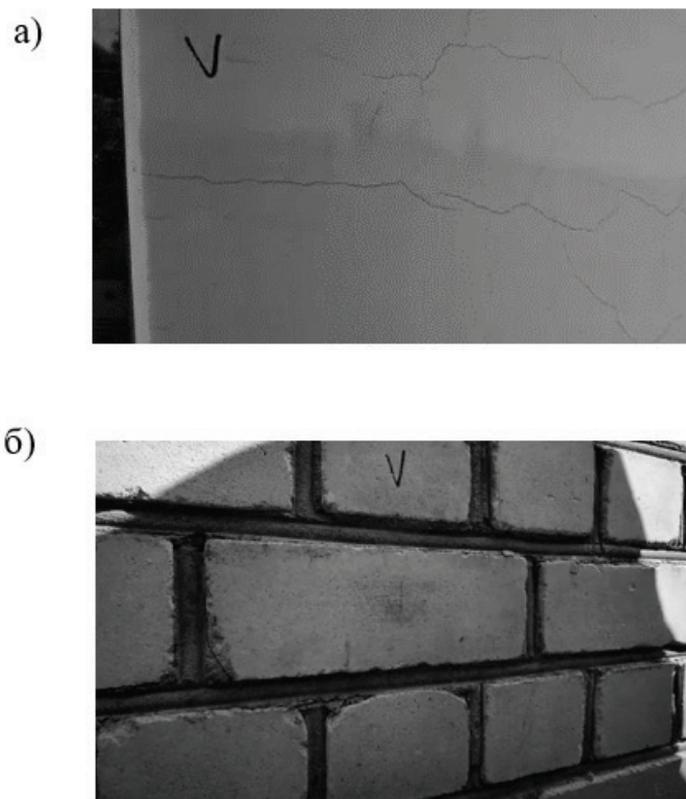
Отметки после очистки: а) оштукатуренный и покрытой краской фасад, б) кирпичная кладка
